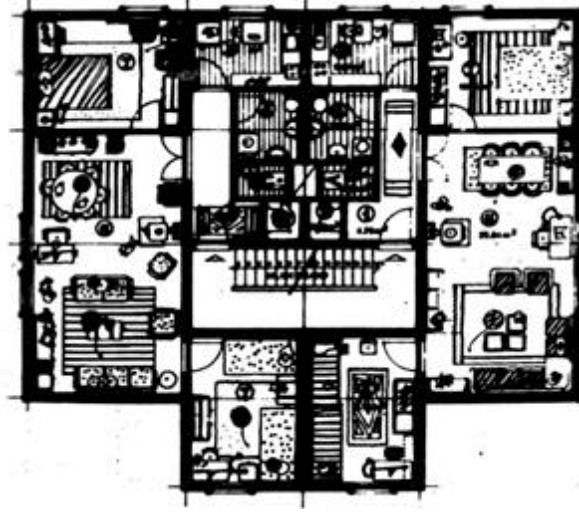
Vaziyet planı (Birkan, 1982)
